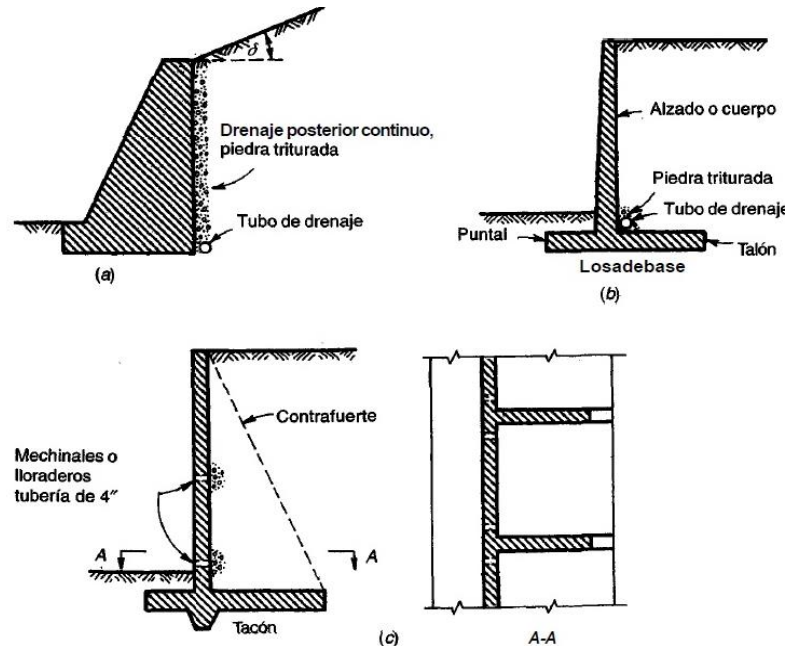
19. Tipos de muro de contención y drenajes posteriores: (a) muro de gravedad; (b) muro en voladizo; (c) muro con contrafuertes.
